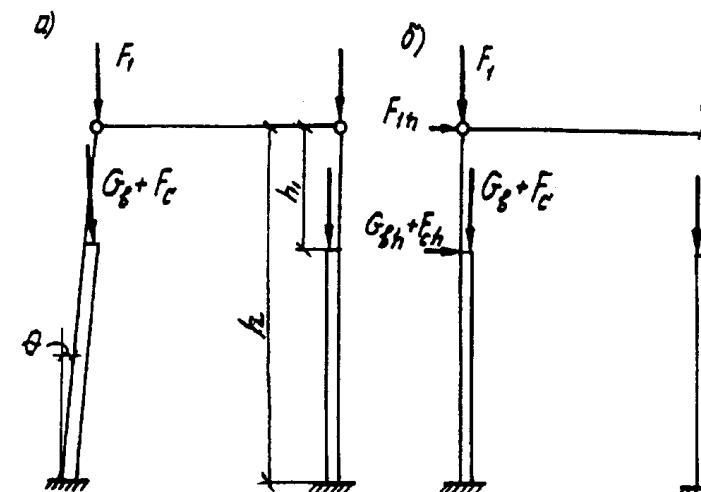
К расчету одноэтажных рам с наклонными стойками (а — расчетная схема рамы с наклонными стойками; б — расчетная схема эквивалентной рамы с вертикальными стойками)
